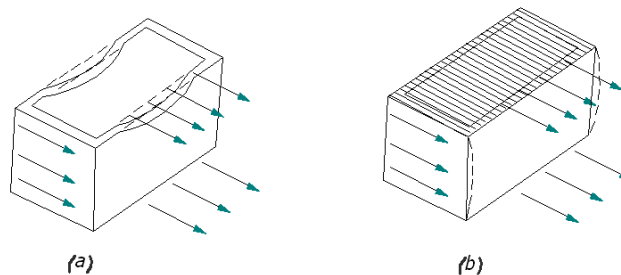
Reagimi i strukturës prej murature nga veprimi sizmik: a - muret janë të lidhura me brez, b- muret janë të lidhura me soletë dhe brez betonarme
